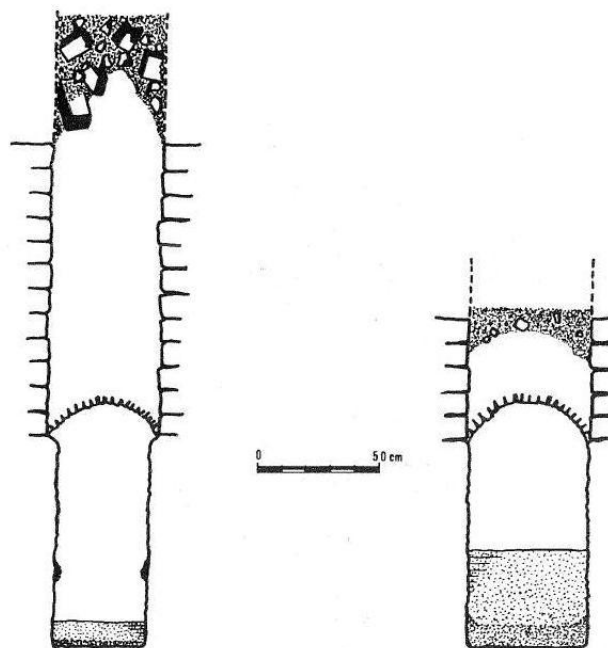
Secciones de los respiraderos detectados en la galería sur (MENDOZA y PEDROCHE, 1996).
